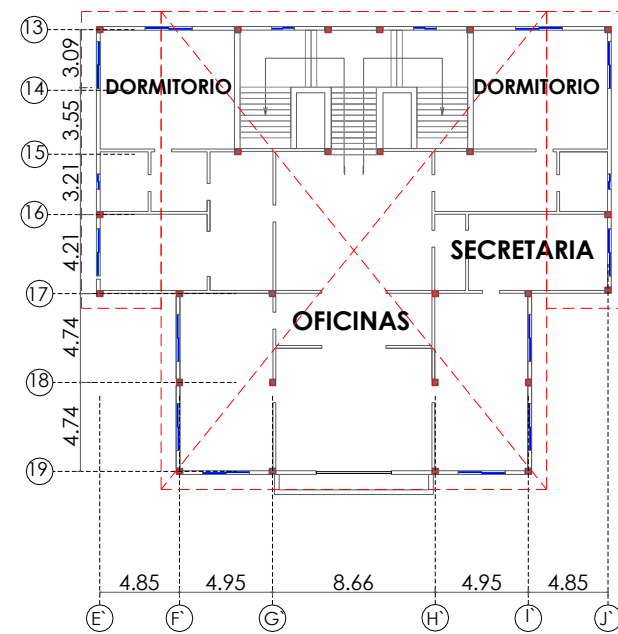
Planta Alta .Ex Academia Militar Juan Gómez Rendón
